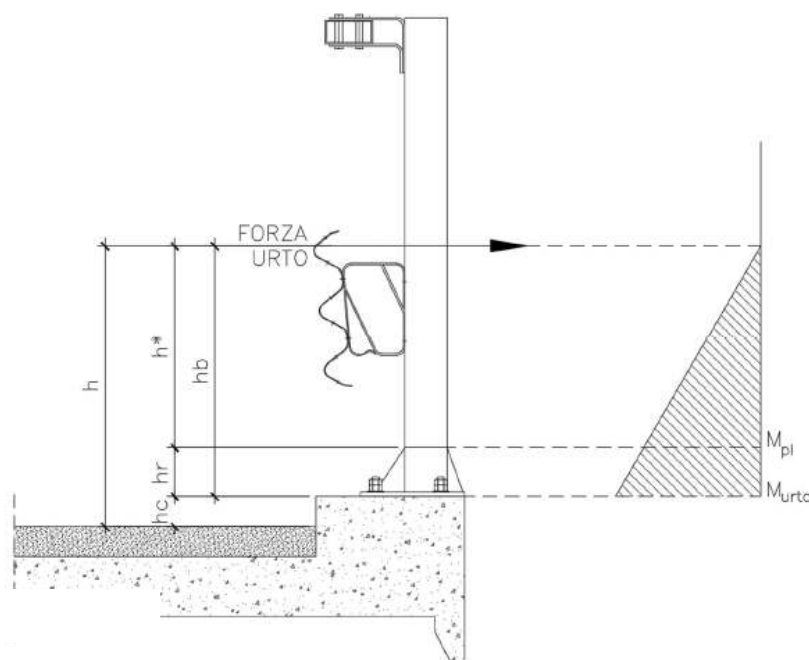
Rappresentazione schematica dell'urto sulla barriera.
